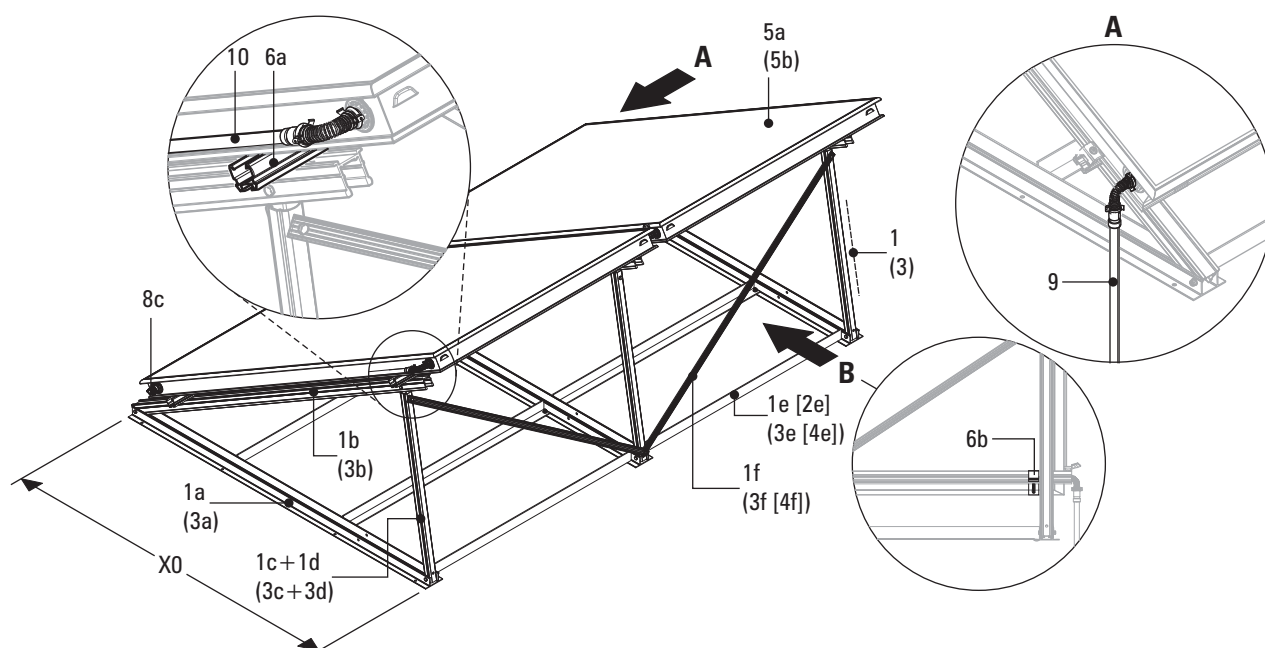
Hoofdafmeting van een Zonne-energie-installatie-collectorveld voor Platdakmontage zonnecollectoren (voorgesteld bij vlakplaatcollector EKS26P in het Drain-Back-systeem)
